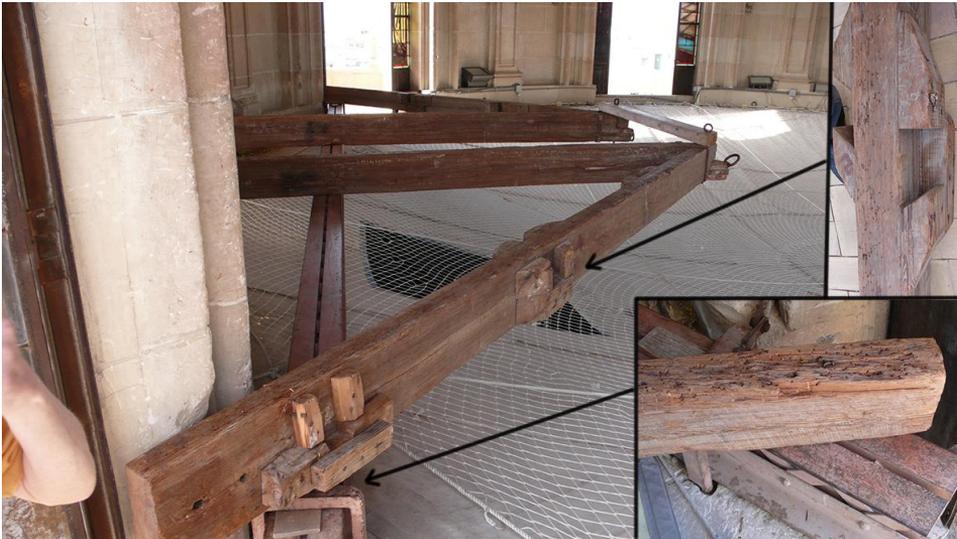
Vista desde la ventana del noreste donde se ve parte de la estructura montada. En primer plano la viga de borde del lado citado que apoya por un extremo sobre la jácena y por el opuesto sobre la de voladizo. En la cara visible se ven las piezas destinadas a albergar las vigas que sostienen al bacalao y el apoyo de esta sobre la jácena.
